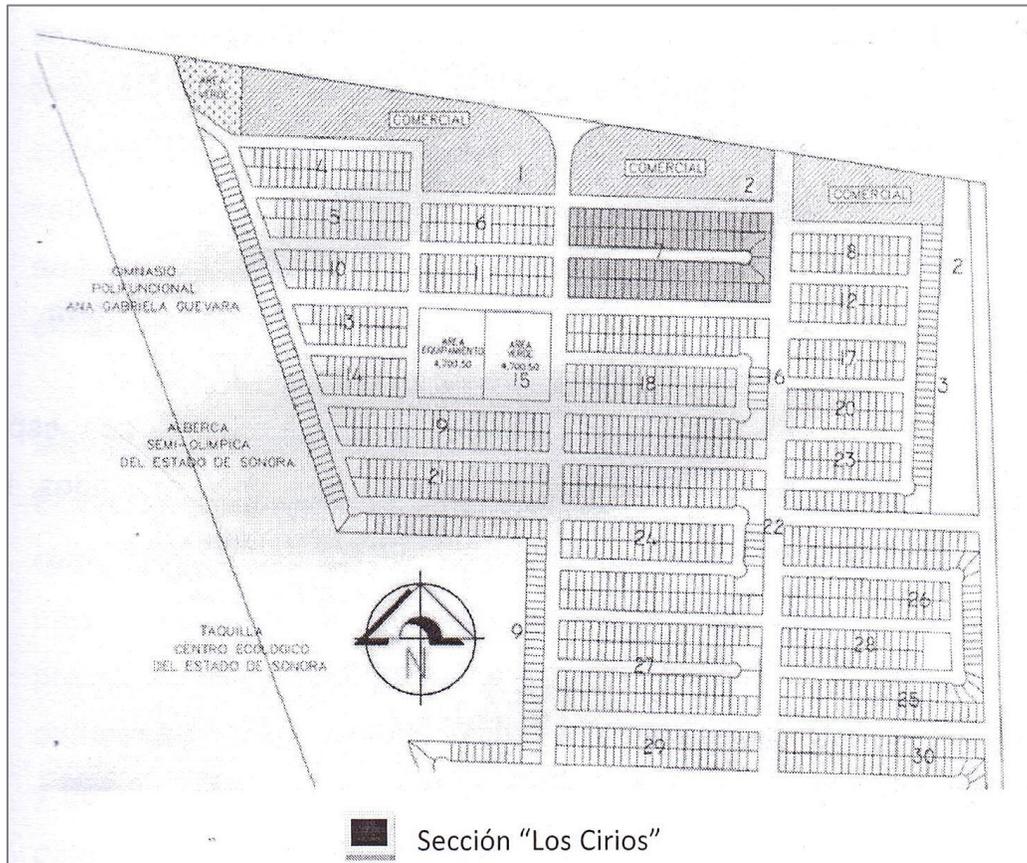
Lotificación, Fraccionamiento Altares. Fuente: Plano en base al proyecto del Fraccionamiento
